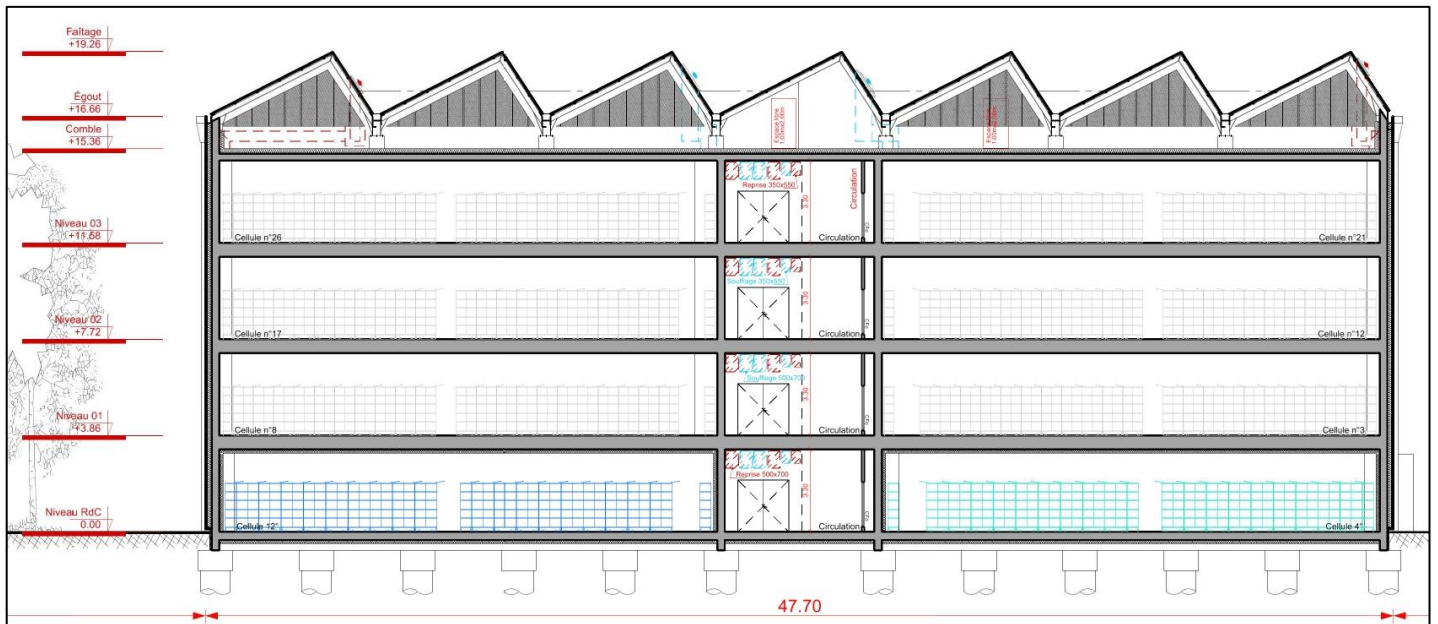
Coupe Ouest-Est du bâtiment projeté (source : ESID BORDEAUX)
